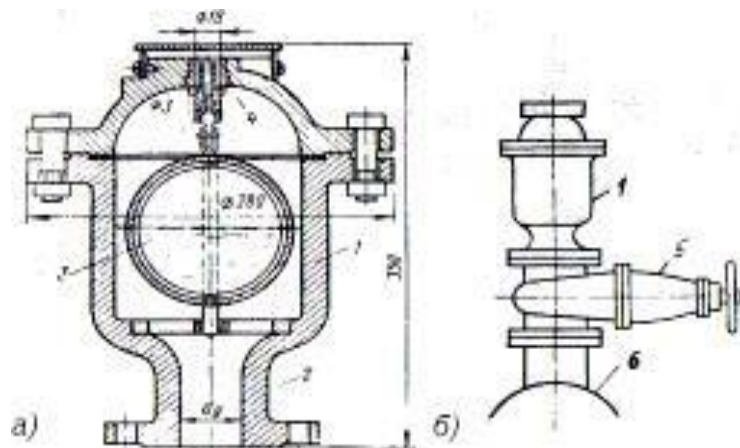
Вантуз: а — загальний вигляд; б— установка на водоводі; 1 — корпус; 2 — горловина; 3 — шаровий поплавков; 4 — клапан для випуску повітря; 5 — засувка; 6 — водовід
